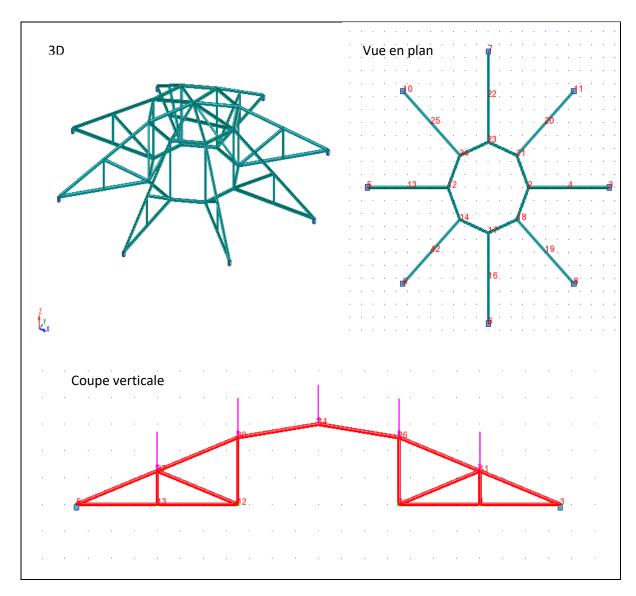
Vue générale de la structure (3D, coupe verticale, Vue en plan)
